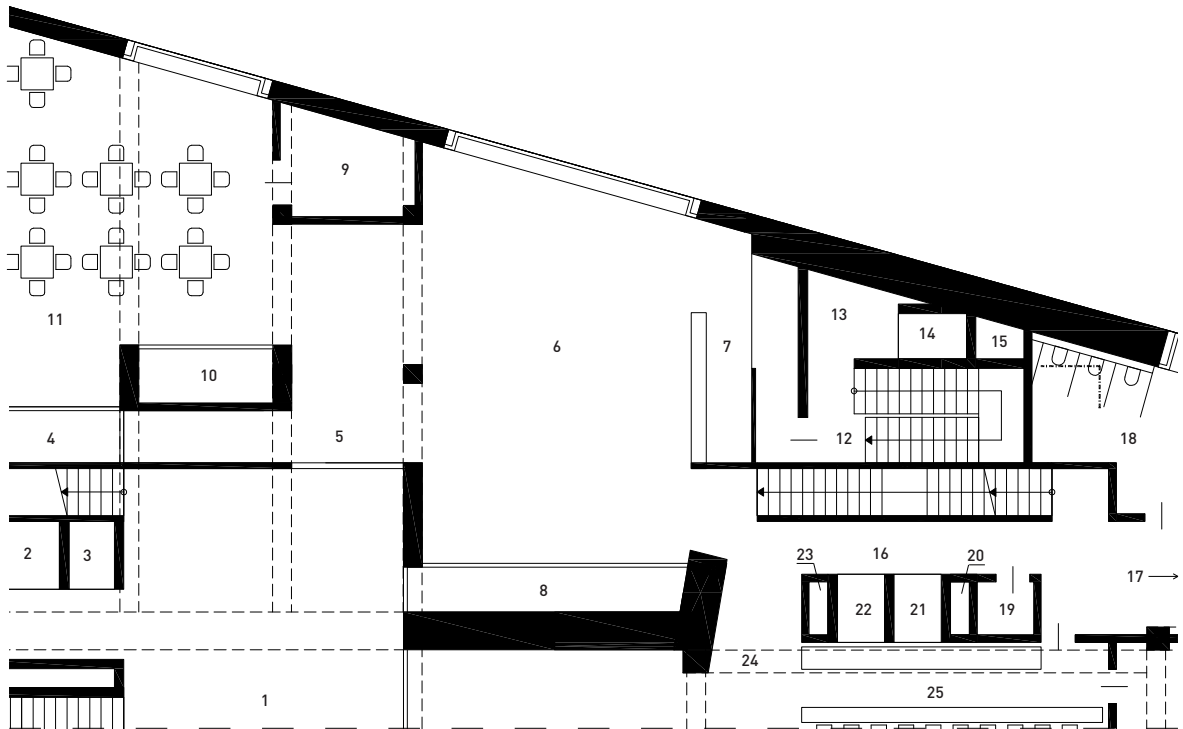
Grundriss Eingangszone Restaurant M1:200
